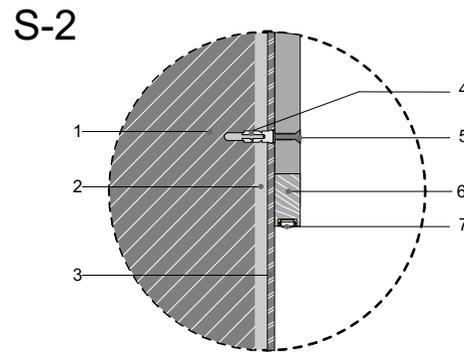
Detalle constructivo mueble alto arco CEDIUC Fuente: Propia
